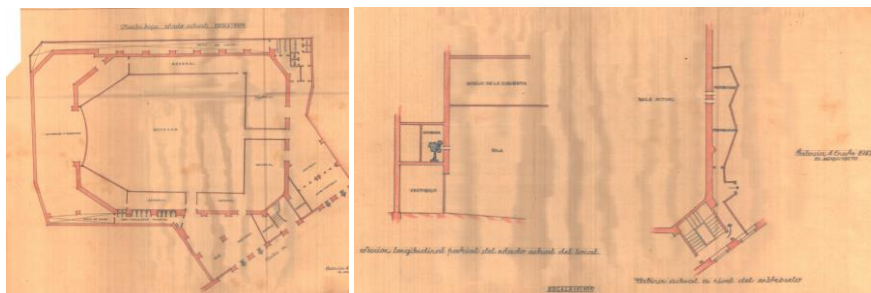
Planta anterior a la intervención de Joaquín Rieta. 02 Lámina con sección longitudinal y planta de la cabina anterior a la intervención de Joaquín Rieta.
